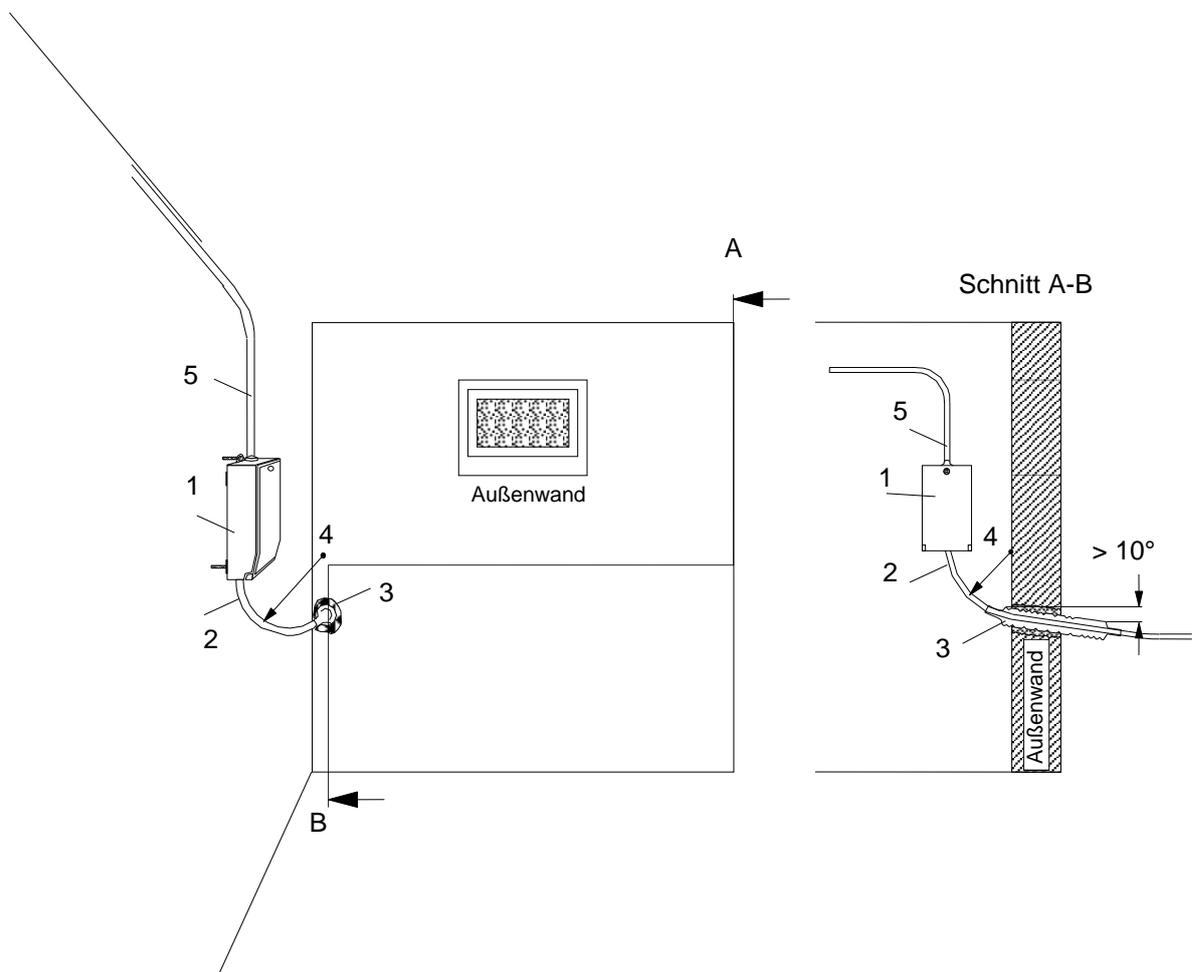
Beispiel für einen Kabel-Netzanschluss, Innenanschlusstechnik
